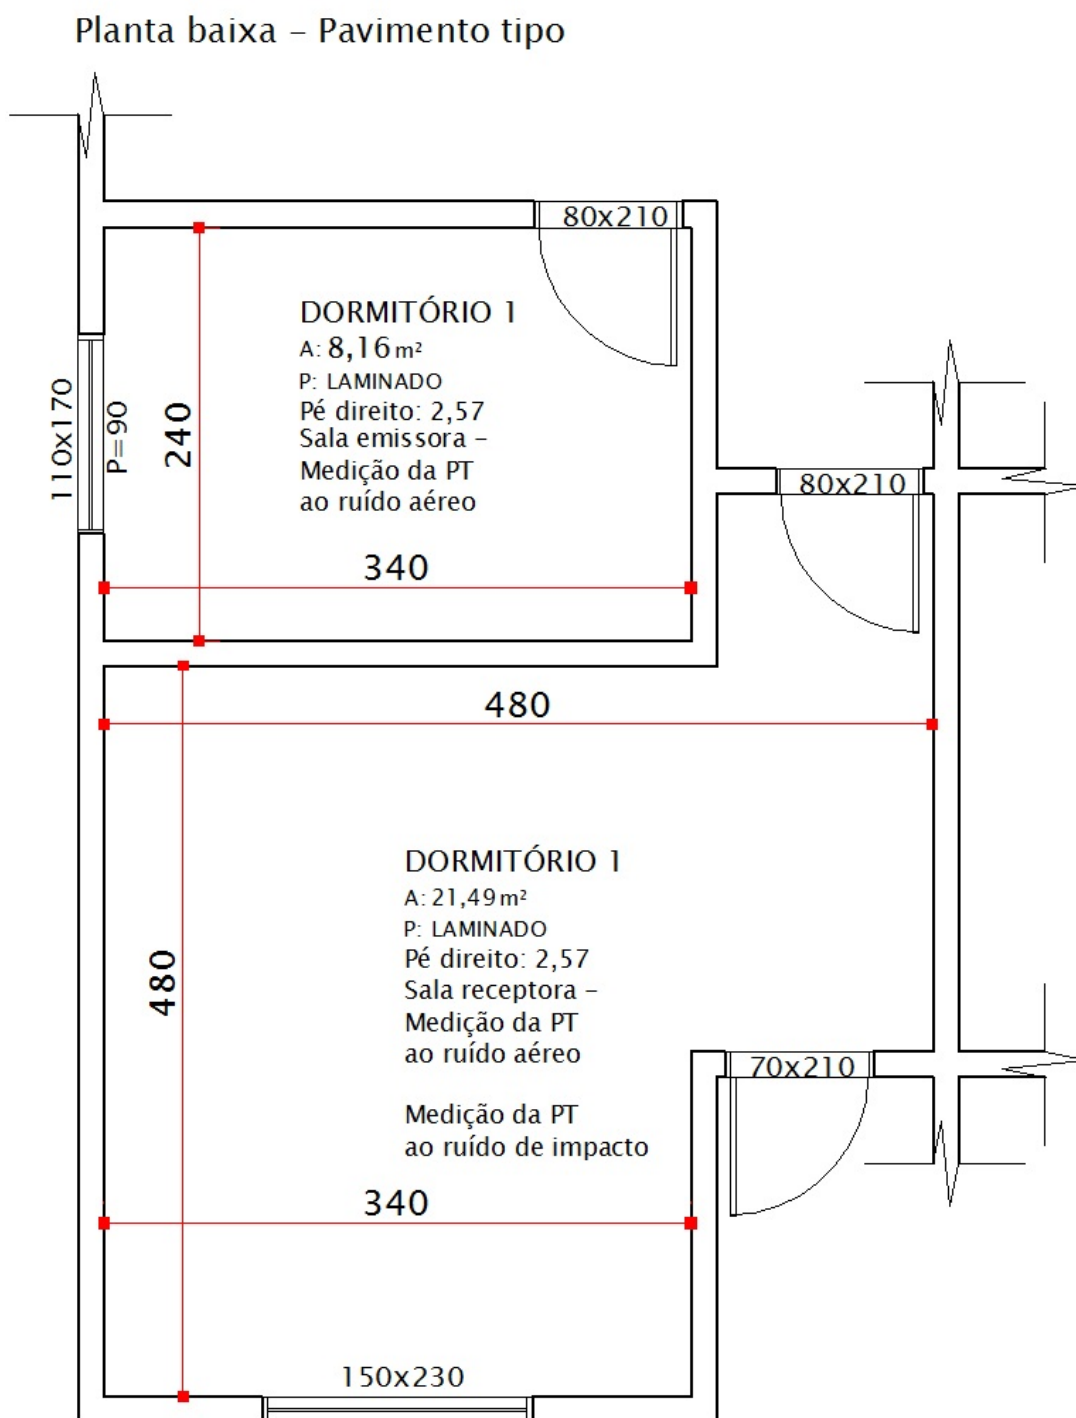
Planta baixa - pavimento tipo - 13-R8-N-BCO-PL
